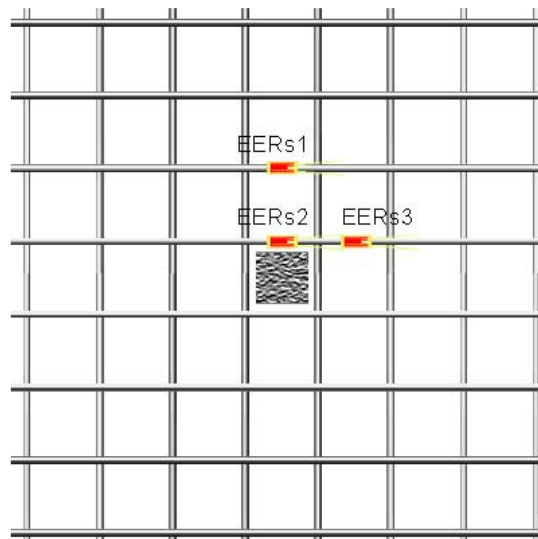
Disposição dos EERs nas armaduras de flexão para pilares com índice de retangularidade 1
